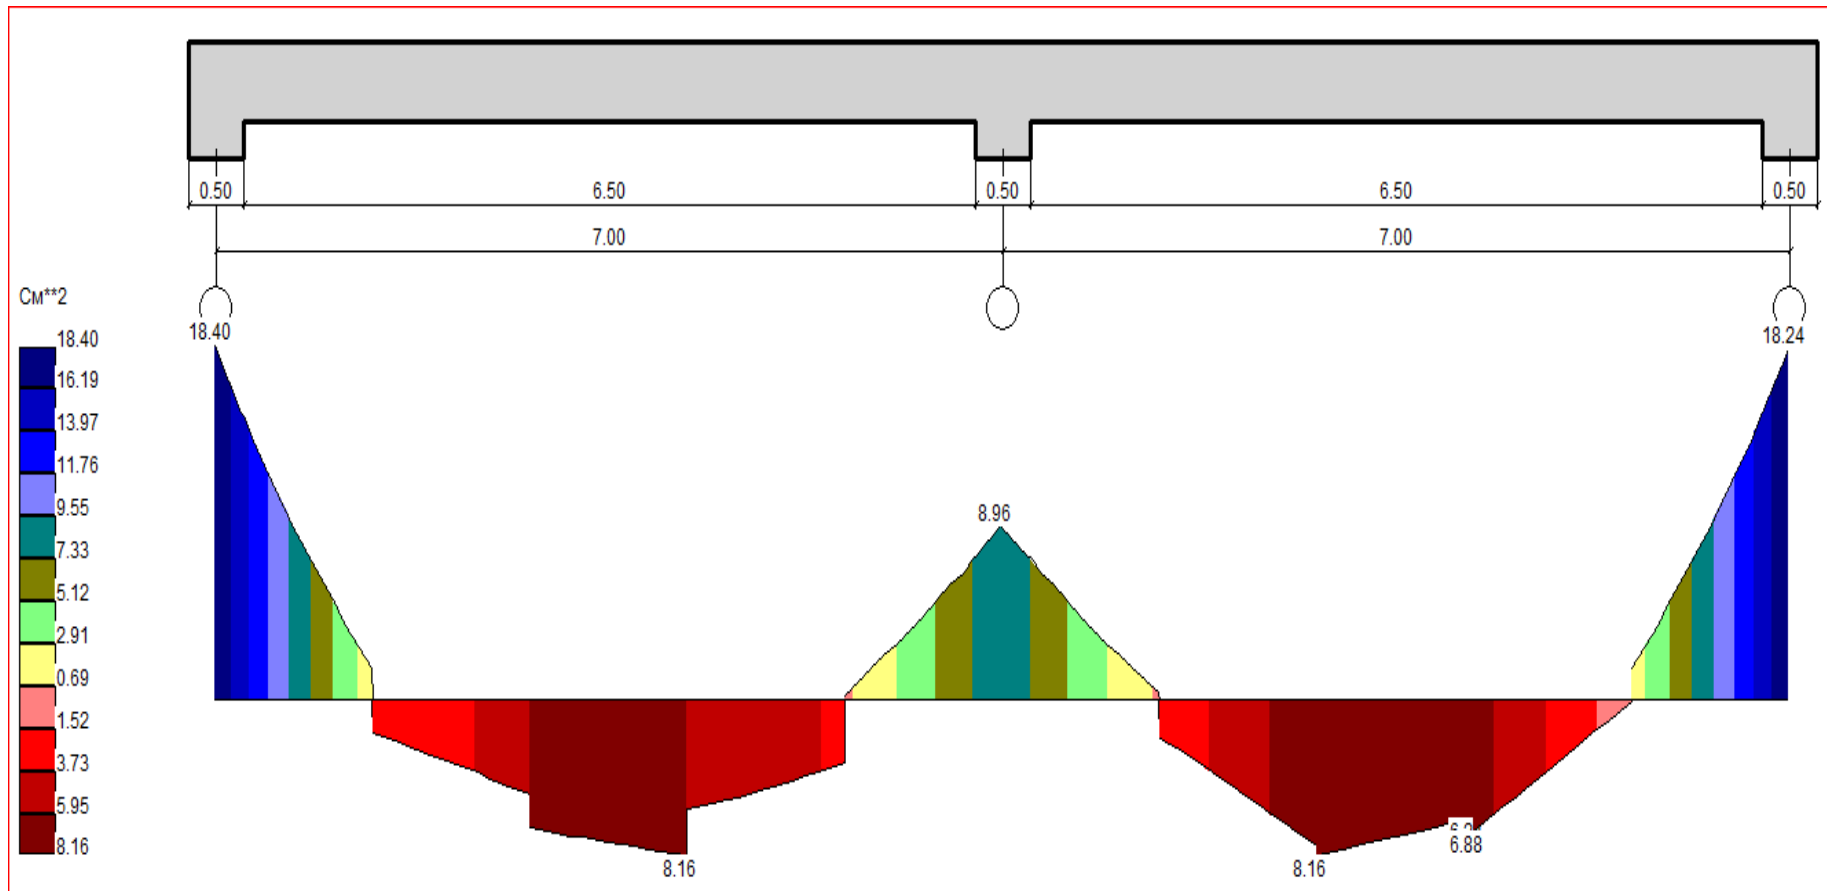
Варіант балково-плитного перекриття. Балка Б6-9. Епюра подовжнього теоретичного армування
